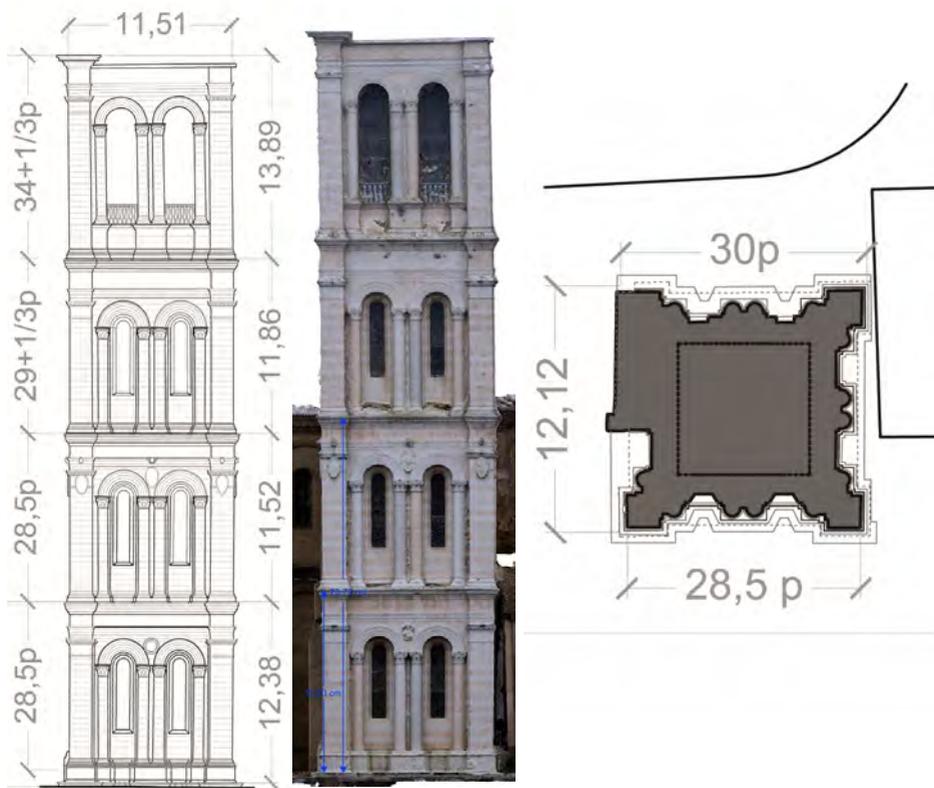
Prospetto lato piazza al CAD; Fitopiano del prospetto sulla piazza; Pianta con riportato il profilo del muro interno ottenuto da altri rilievi.
